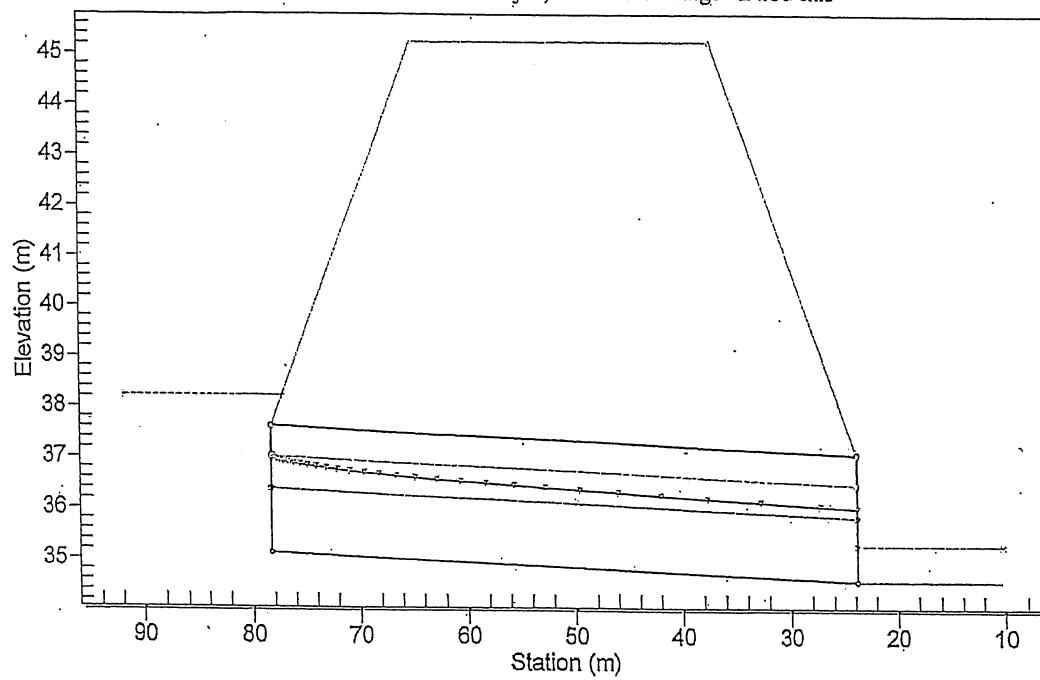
Sección Longitudinal de la Alcantarilla para el Caudal de 1 en 50 Años
